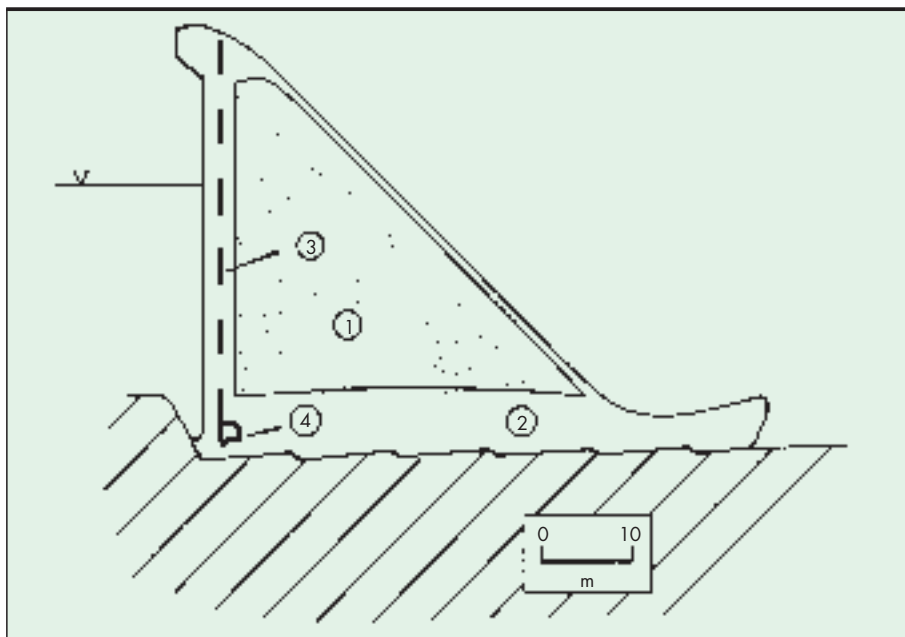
Sección de la presa de PDC (España). Hormigón compactado (1). Hormigón convencional (2). Sistema de drenaje (3). Galería (4).
